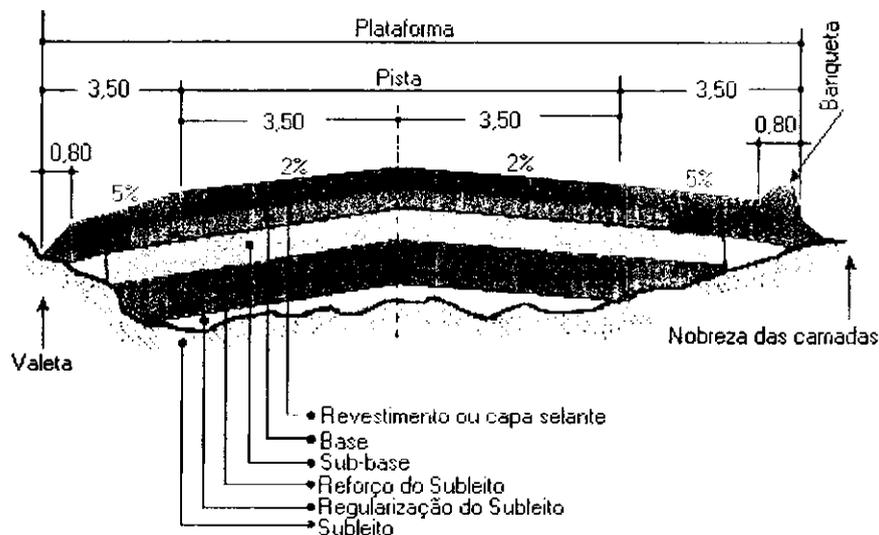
Seção Transversal Típica de Pavimento Flexível
